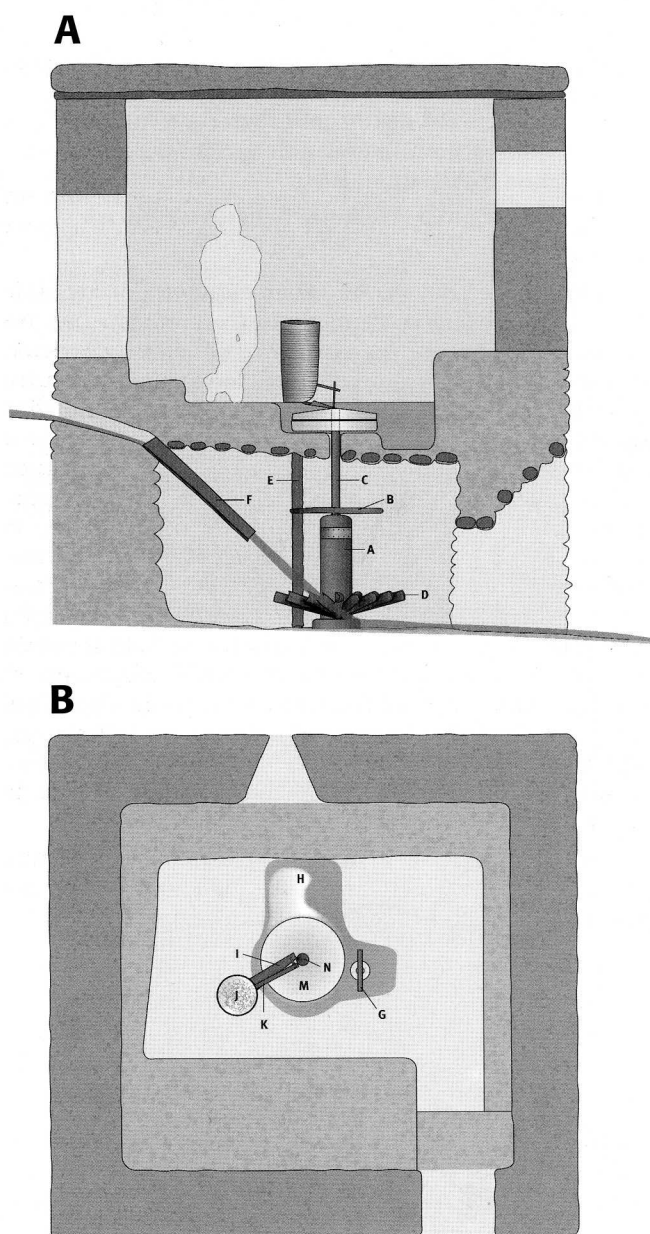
Vues en plan du moulin au niveau du rez-de-chaussée et du sous-sol et coupe. Légende cf. Fig. 5.
